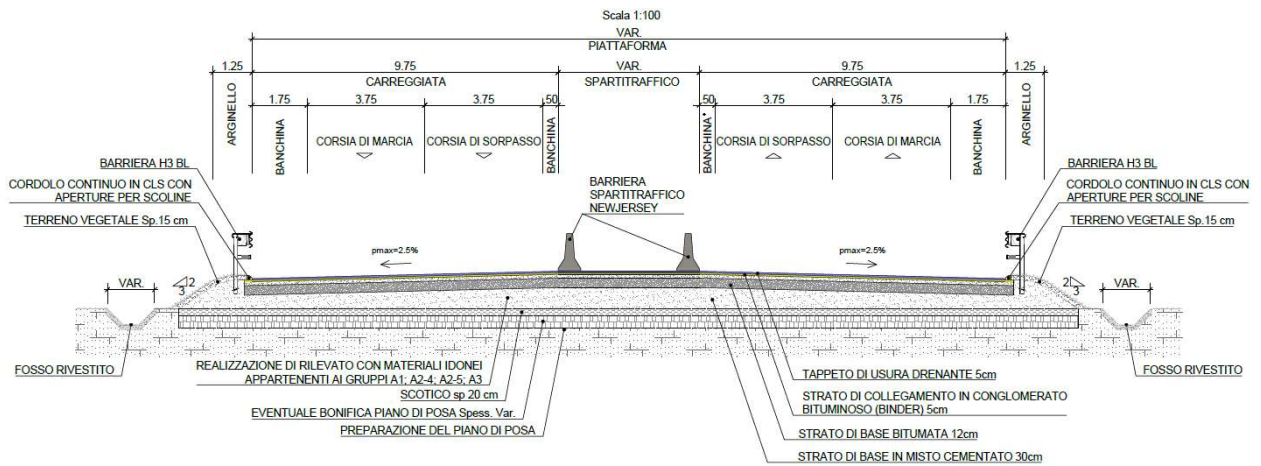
Sezione tipo in rilevato in rettilo senza pista di servizio
